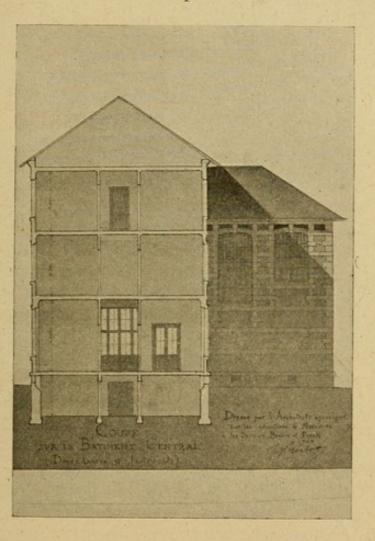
Le nouveau service d'accouchement. Coupe du bâtiment central.
